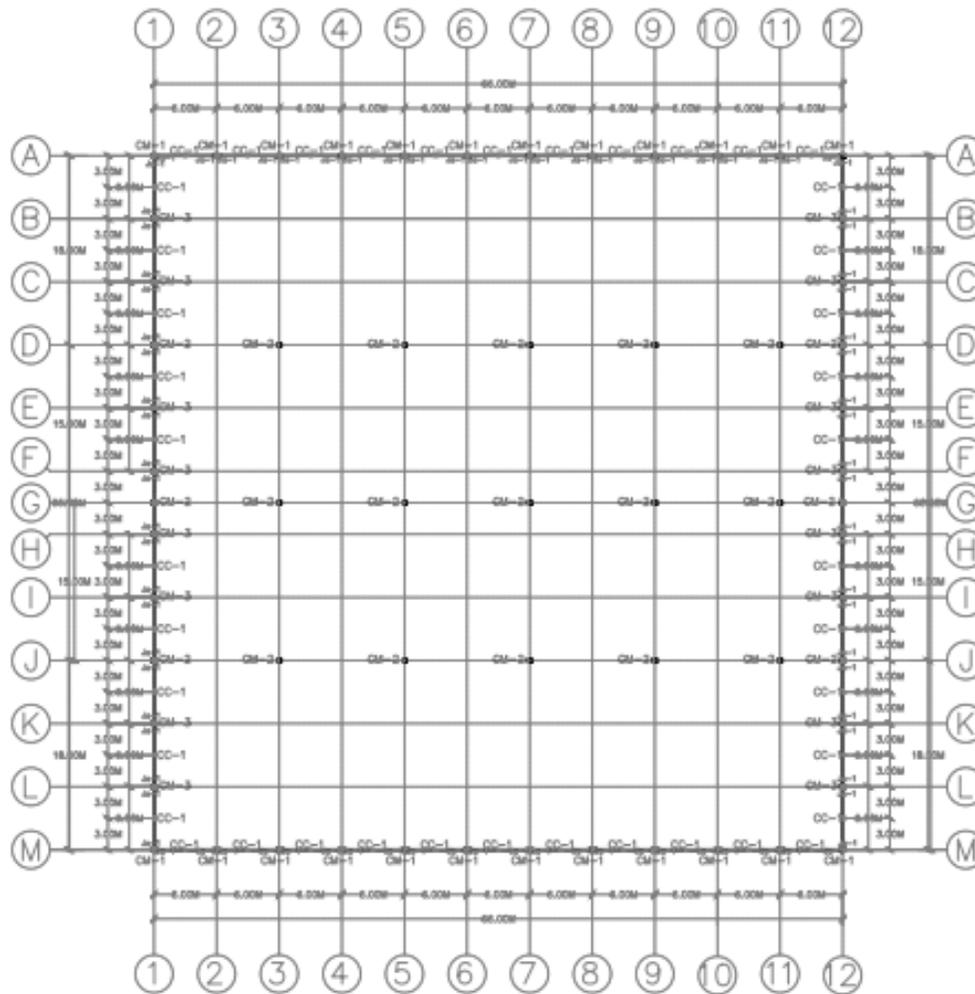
Plano arquitectónico Nave 2 Oficinas 1er Nivel Inflex
